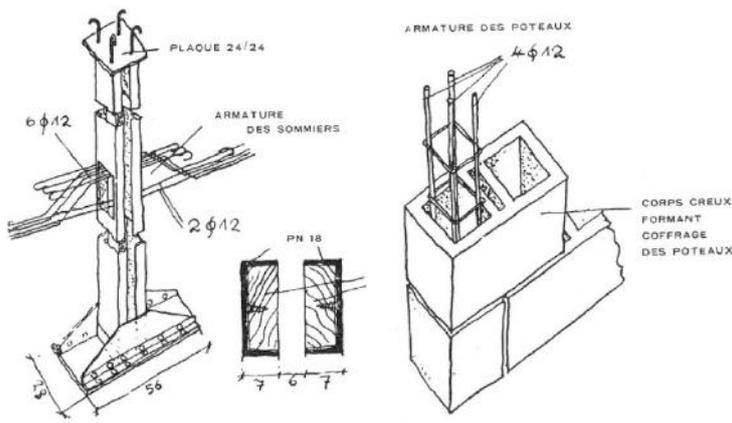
A la izquierda, detalle del pilar de hierro compuesto por dos perfiles con las armaduras soldadas a la altura del forjado de vivienda. A la derecha, detalle del pilar ejecutado en la cámara hueca del bloque de piedra pómez.
